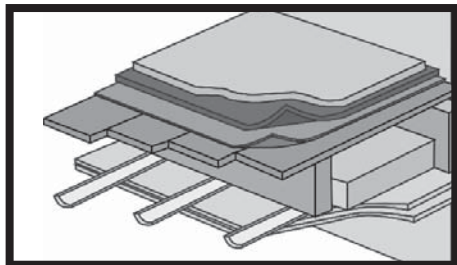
Данная строительная система состоит из деревянного дощатого пола, прибитого к находящейся ниже обрешетке из балок. Укладка на данную систему сравнима с "укладкой на дерево - Рис.39": Соблюдайте приведенные там инструкции.
